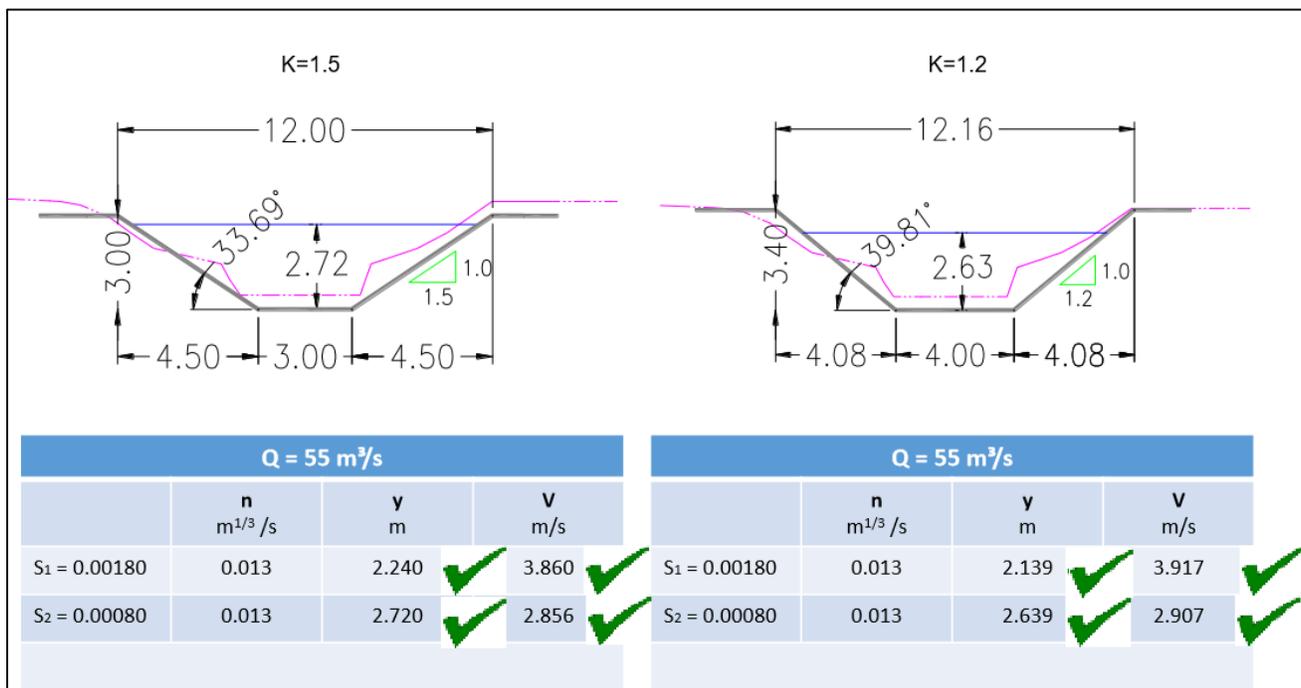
Opción 1 Sección de concreto con fondo fijo (con plantilla de concreto).
